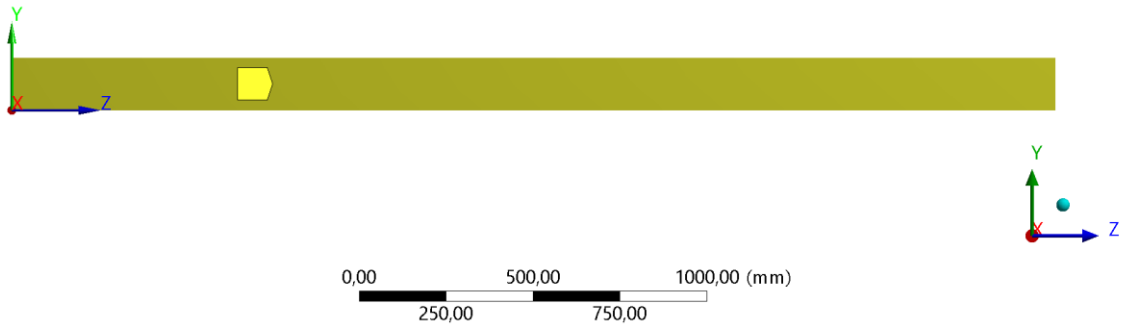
Vista do interior da viga dividida longitudinalmente segundo o plano de simetria yz, deslocamento fixo segundo x – viga 75x150x6000 mm.
